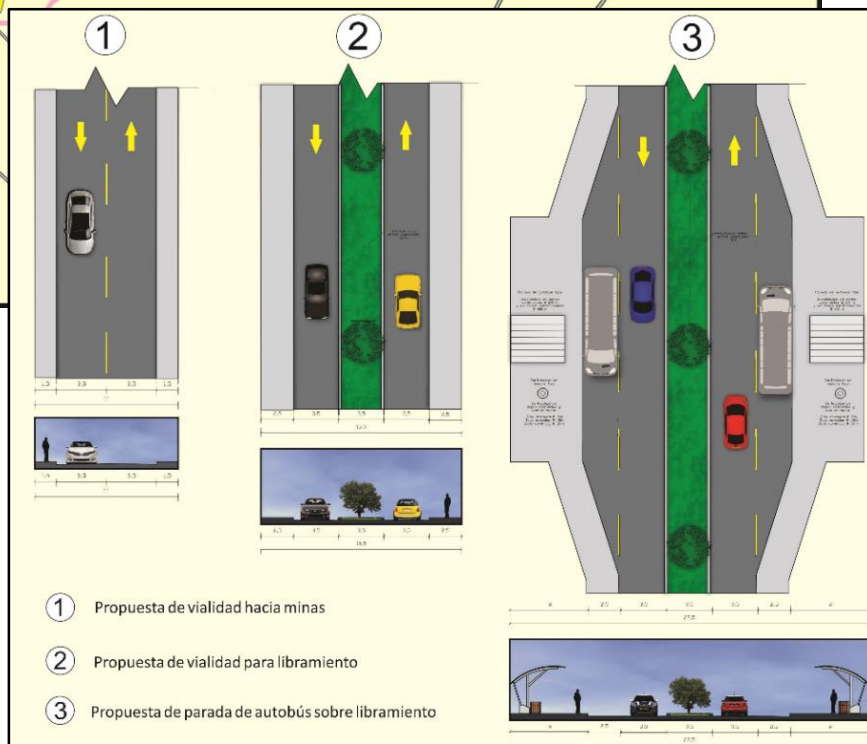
Planta y corte esquemático de propuestas viales para Mineral de Pozos.
